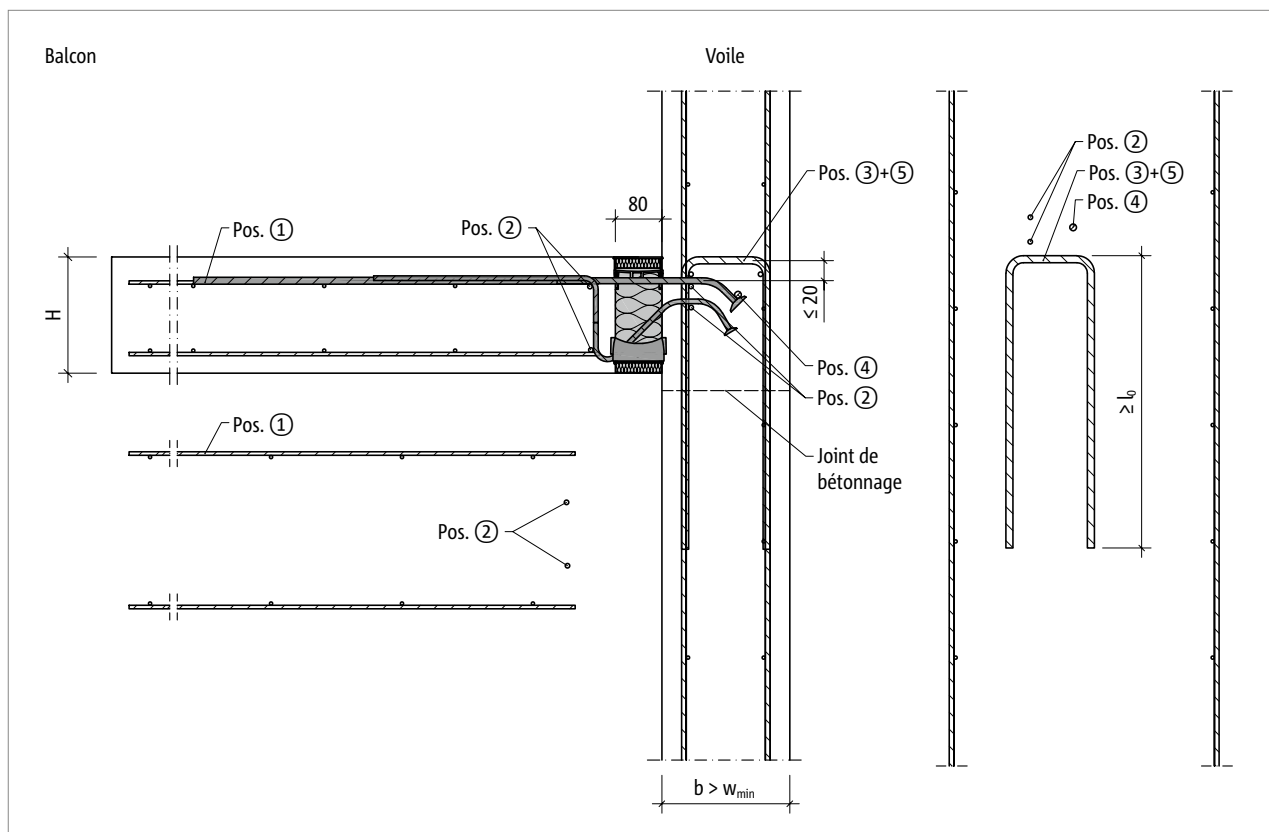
Schöck Isokorb® T type K-O : Renforcement sur site pour raccordement mural avec une dimension plus grande du composant ($w_{pres} > w_{min}$)
